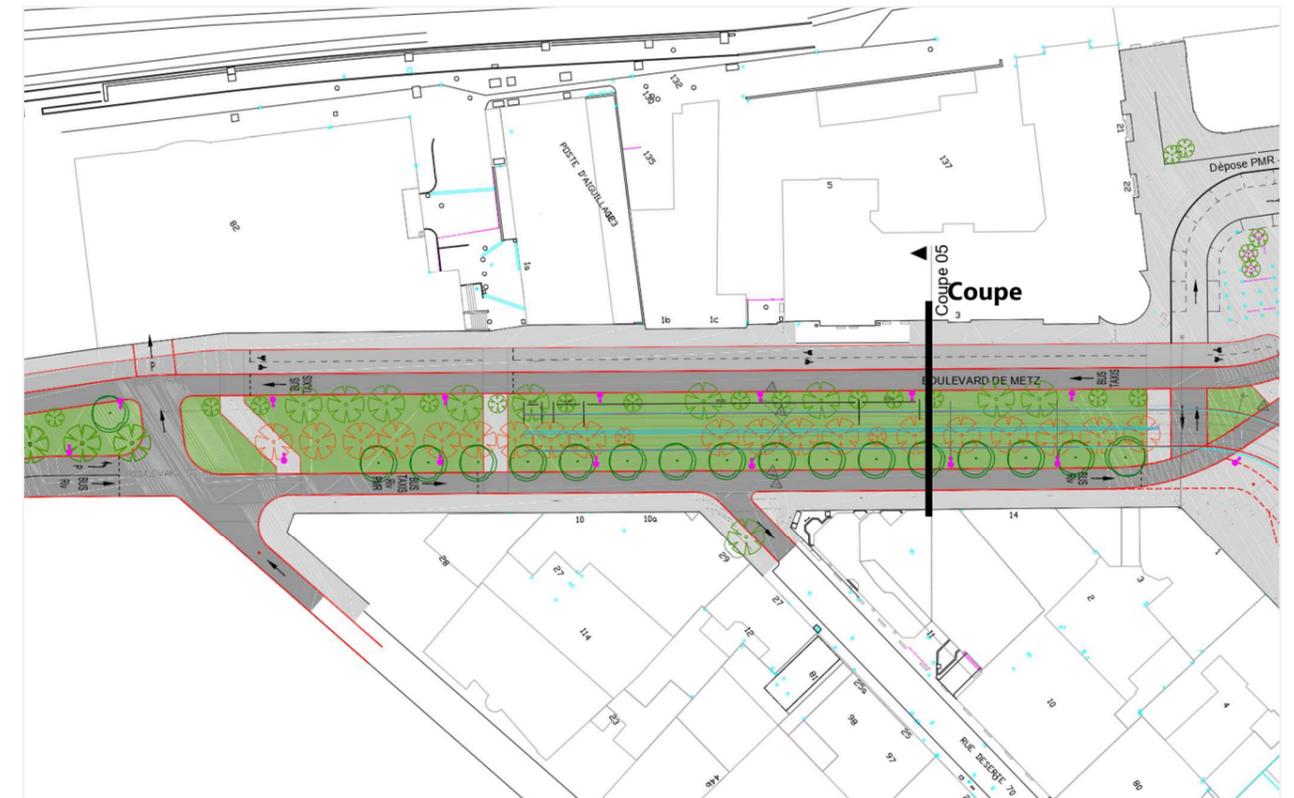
Plan de l'aménagement sur le boulevard de Metz (source : AVP GETAS 2023)
